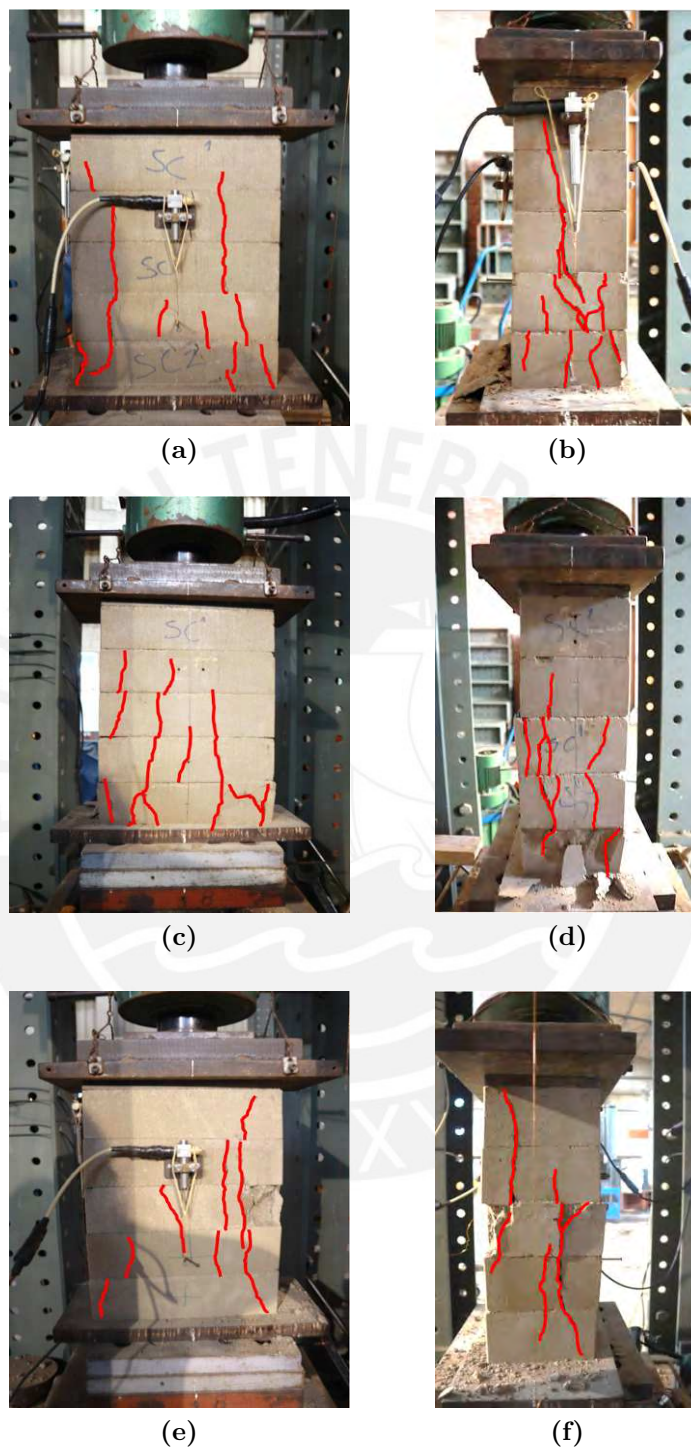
Patrones de falla del ensayo de compresión en pilas PC: (a-c-e) fallas generadas en una de las caras longitudinales y (b-d-f) fallas generadas en la cara transversal.
